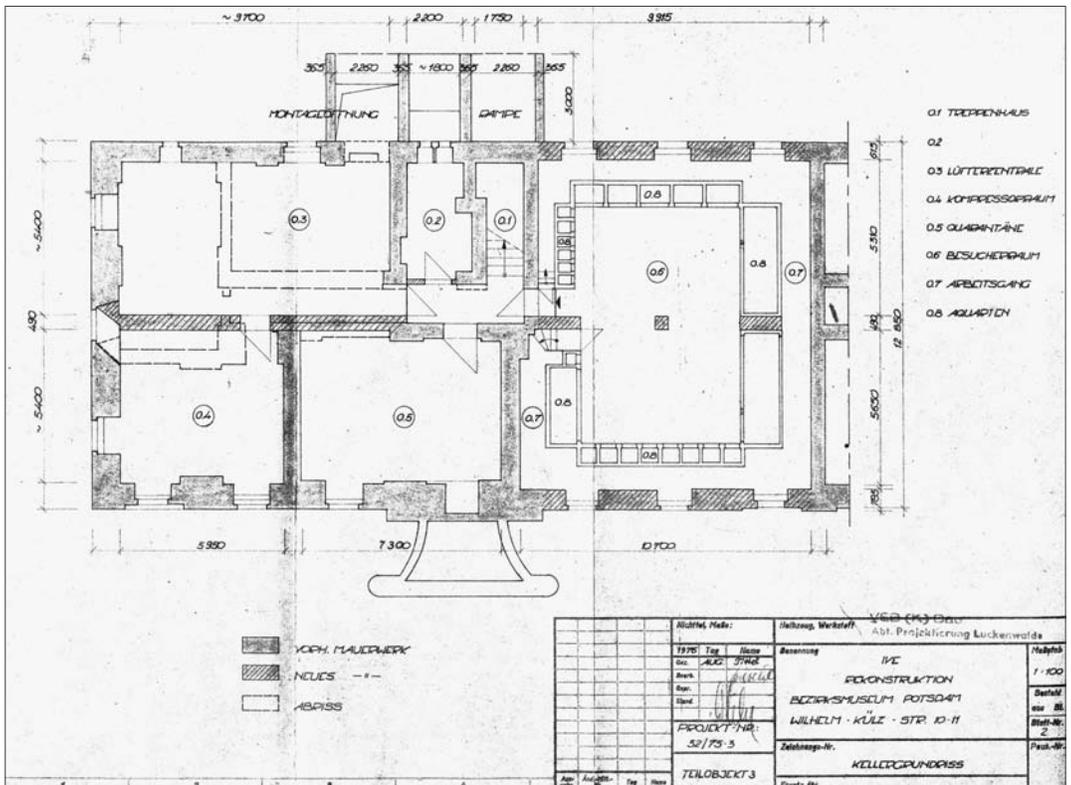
Grundriss des Aquariums, Planung 1975. Repro: Naturkundemuseum Potsdam.
